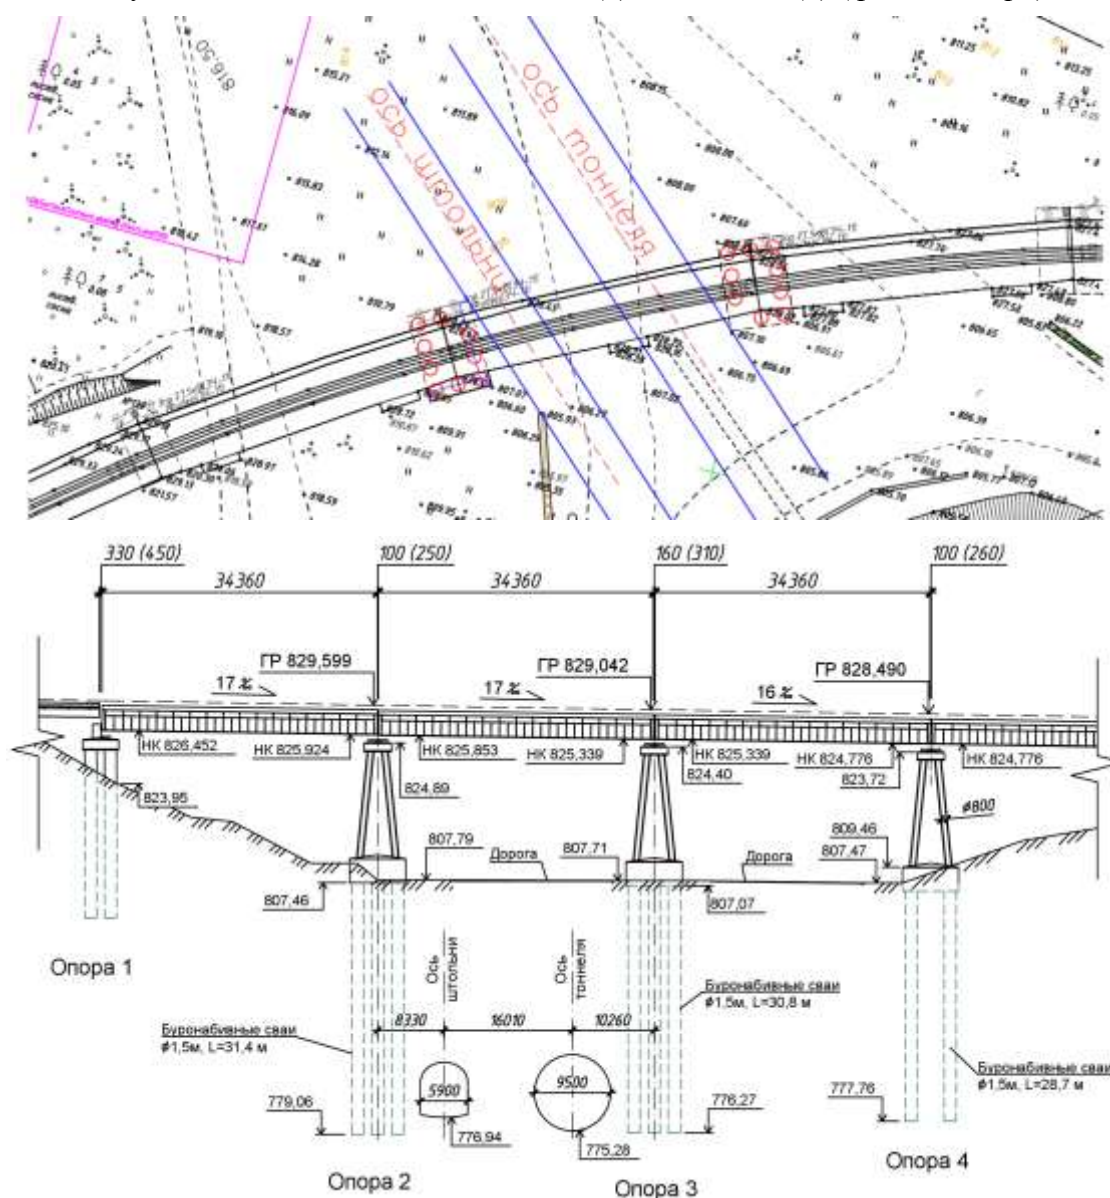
Маркшейдерский план с нанесенным планом тоннеля и фундаментов путепровода (схемы составлены автором)
